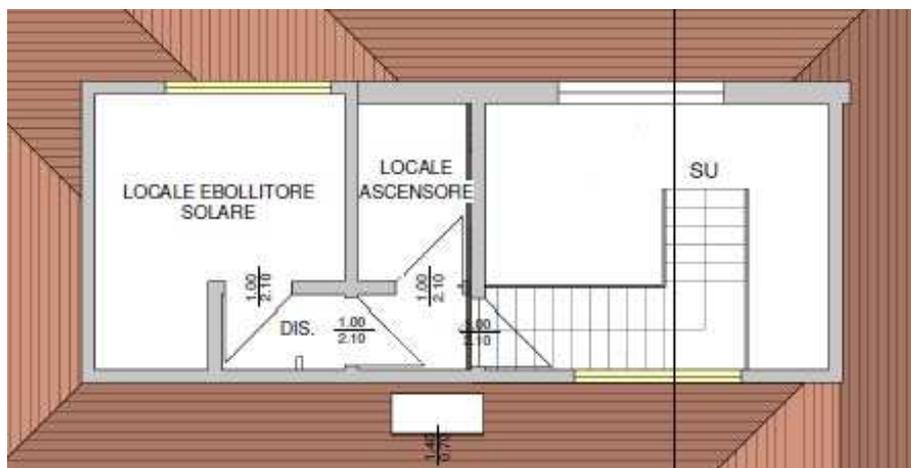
Stralcio pianta locale ebollitore solare e ascensore
